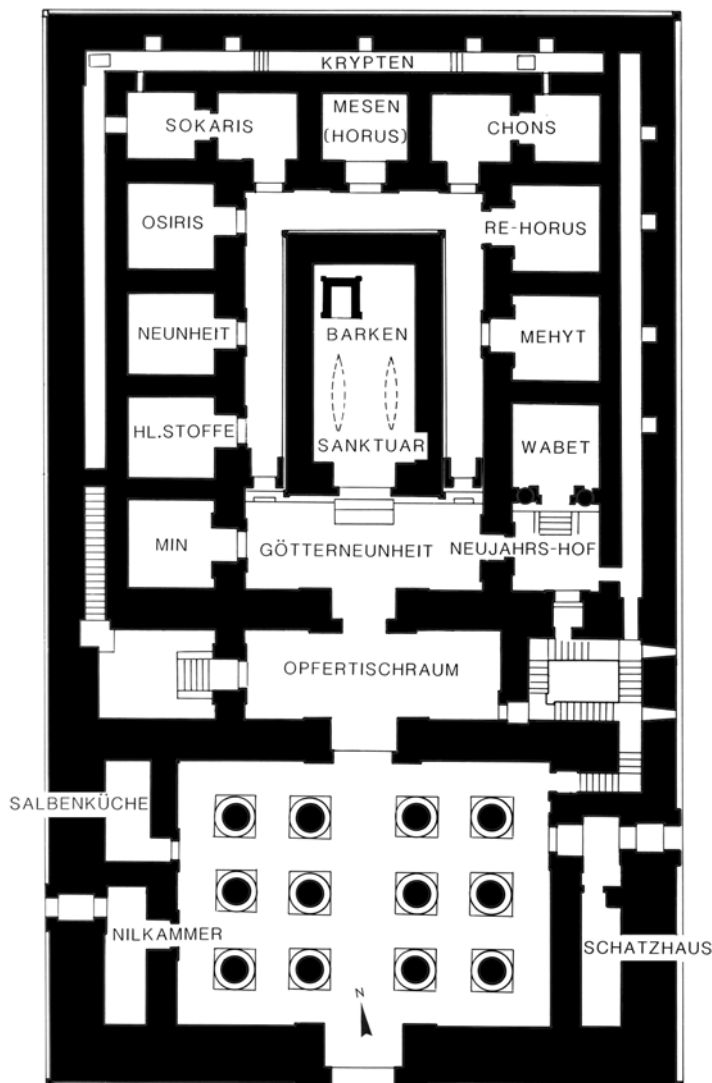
Grundriss Horus-Tempel/Edfu
